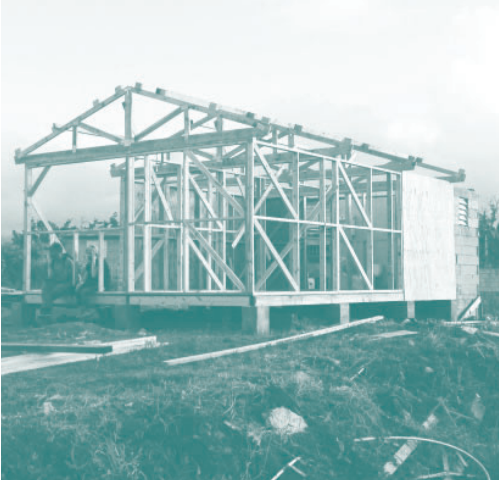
Vivienda en proceso de construcción, con entramado de madera y reutilización de estructura preexistente. (Fuente: TECHO/Francisco Susmel)
